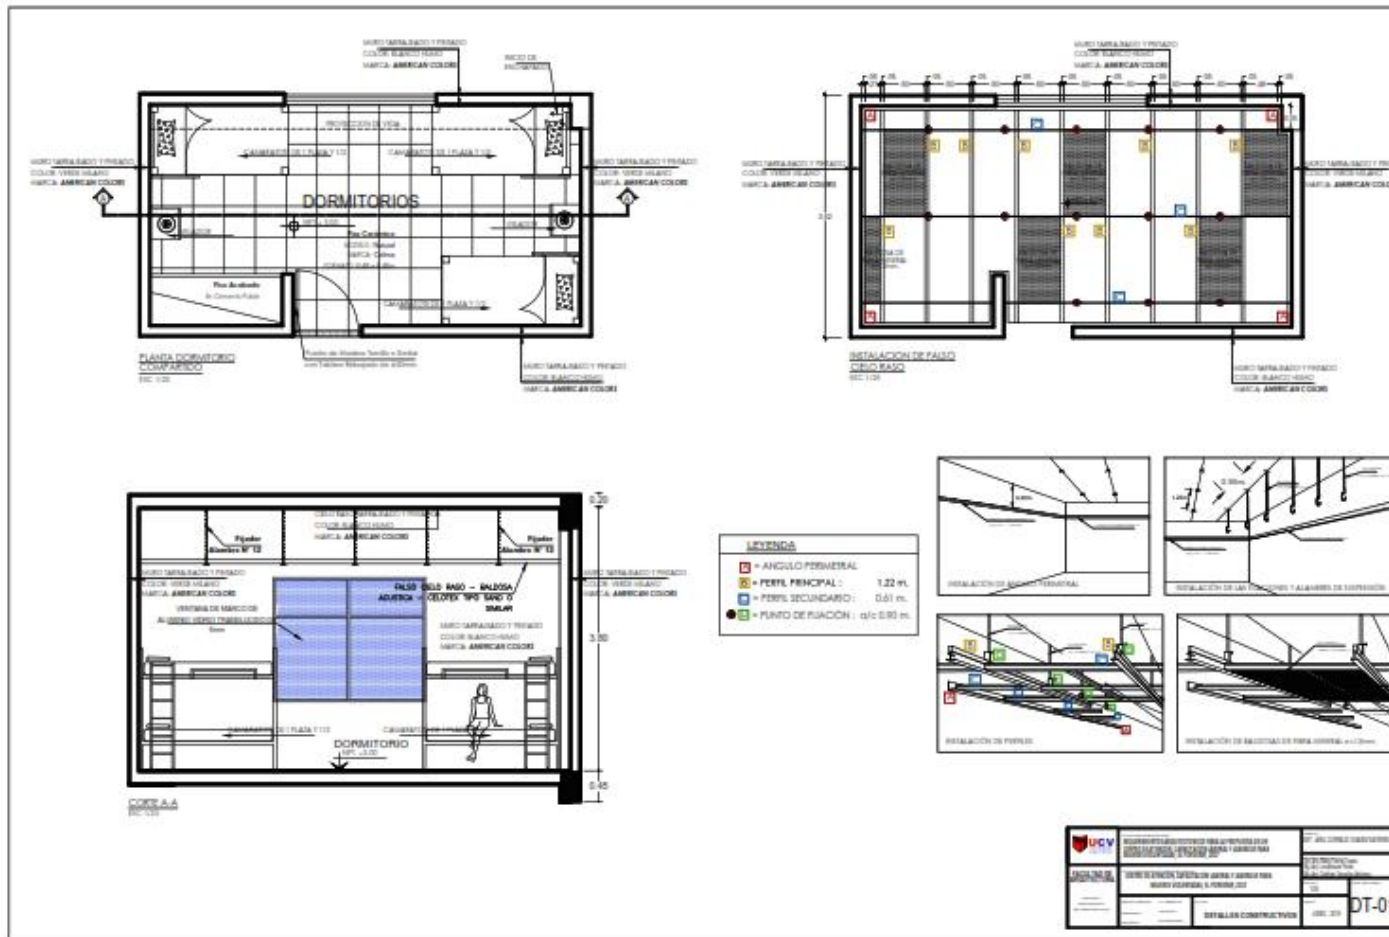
Plano de Detalles Arquitectónicos y Constructivos.
